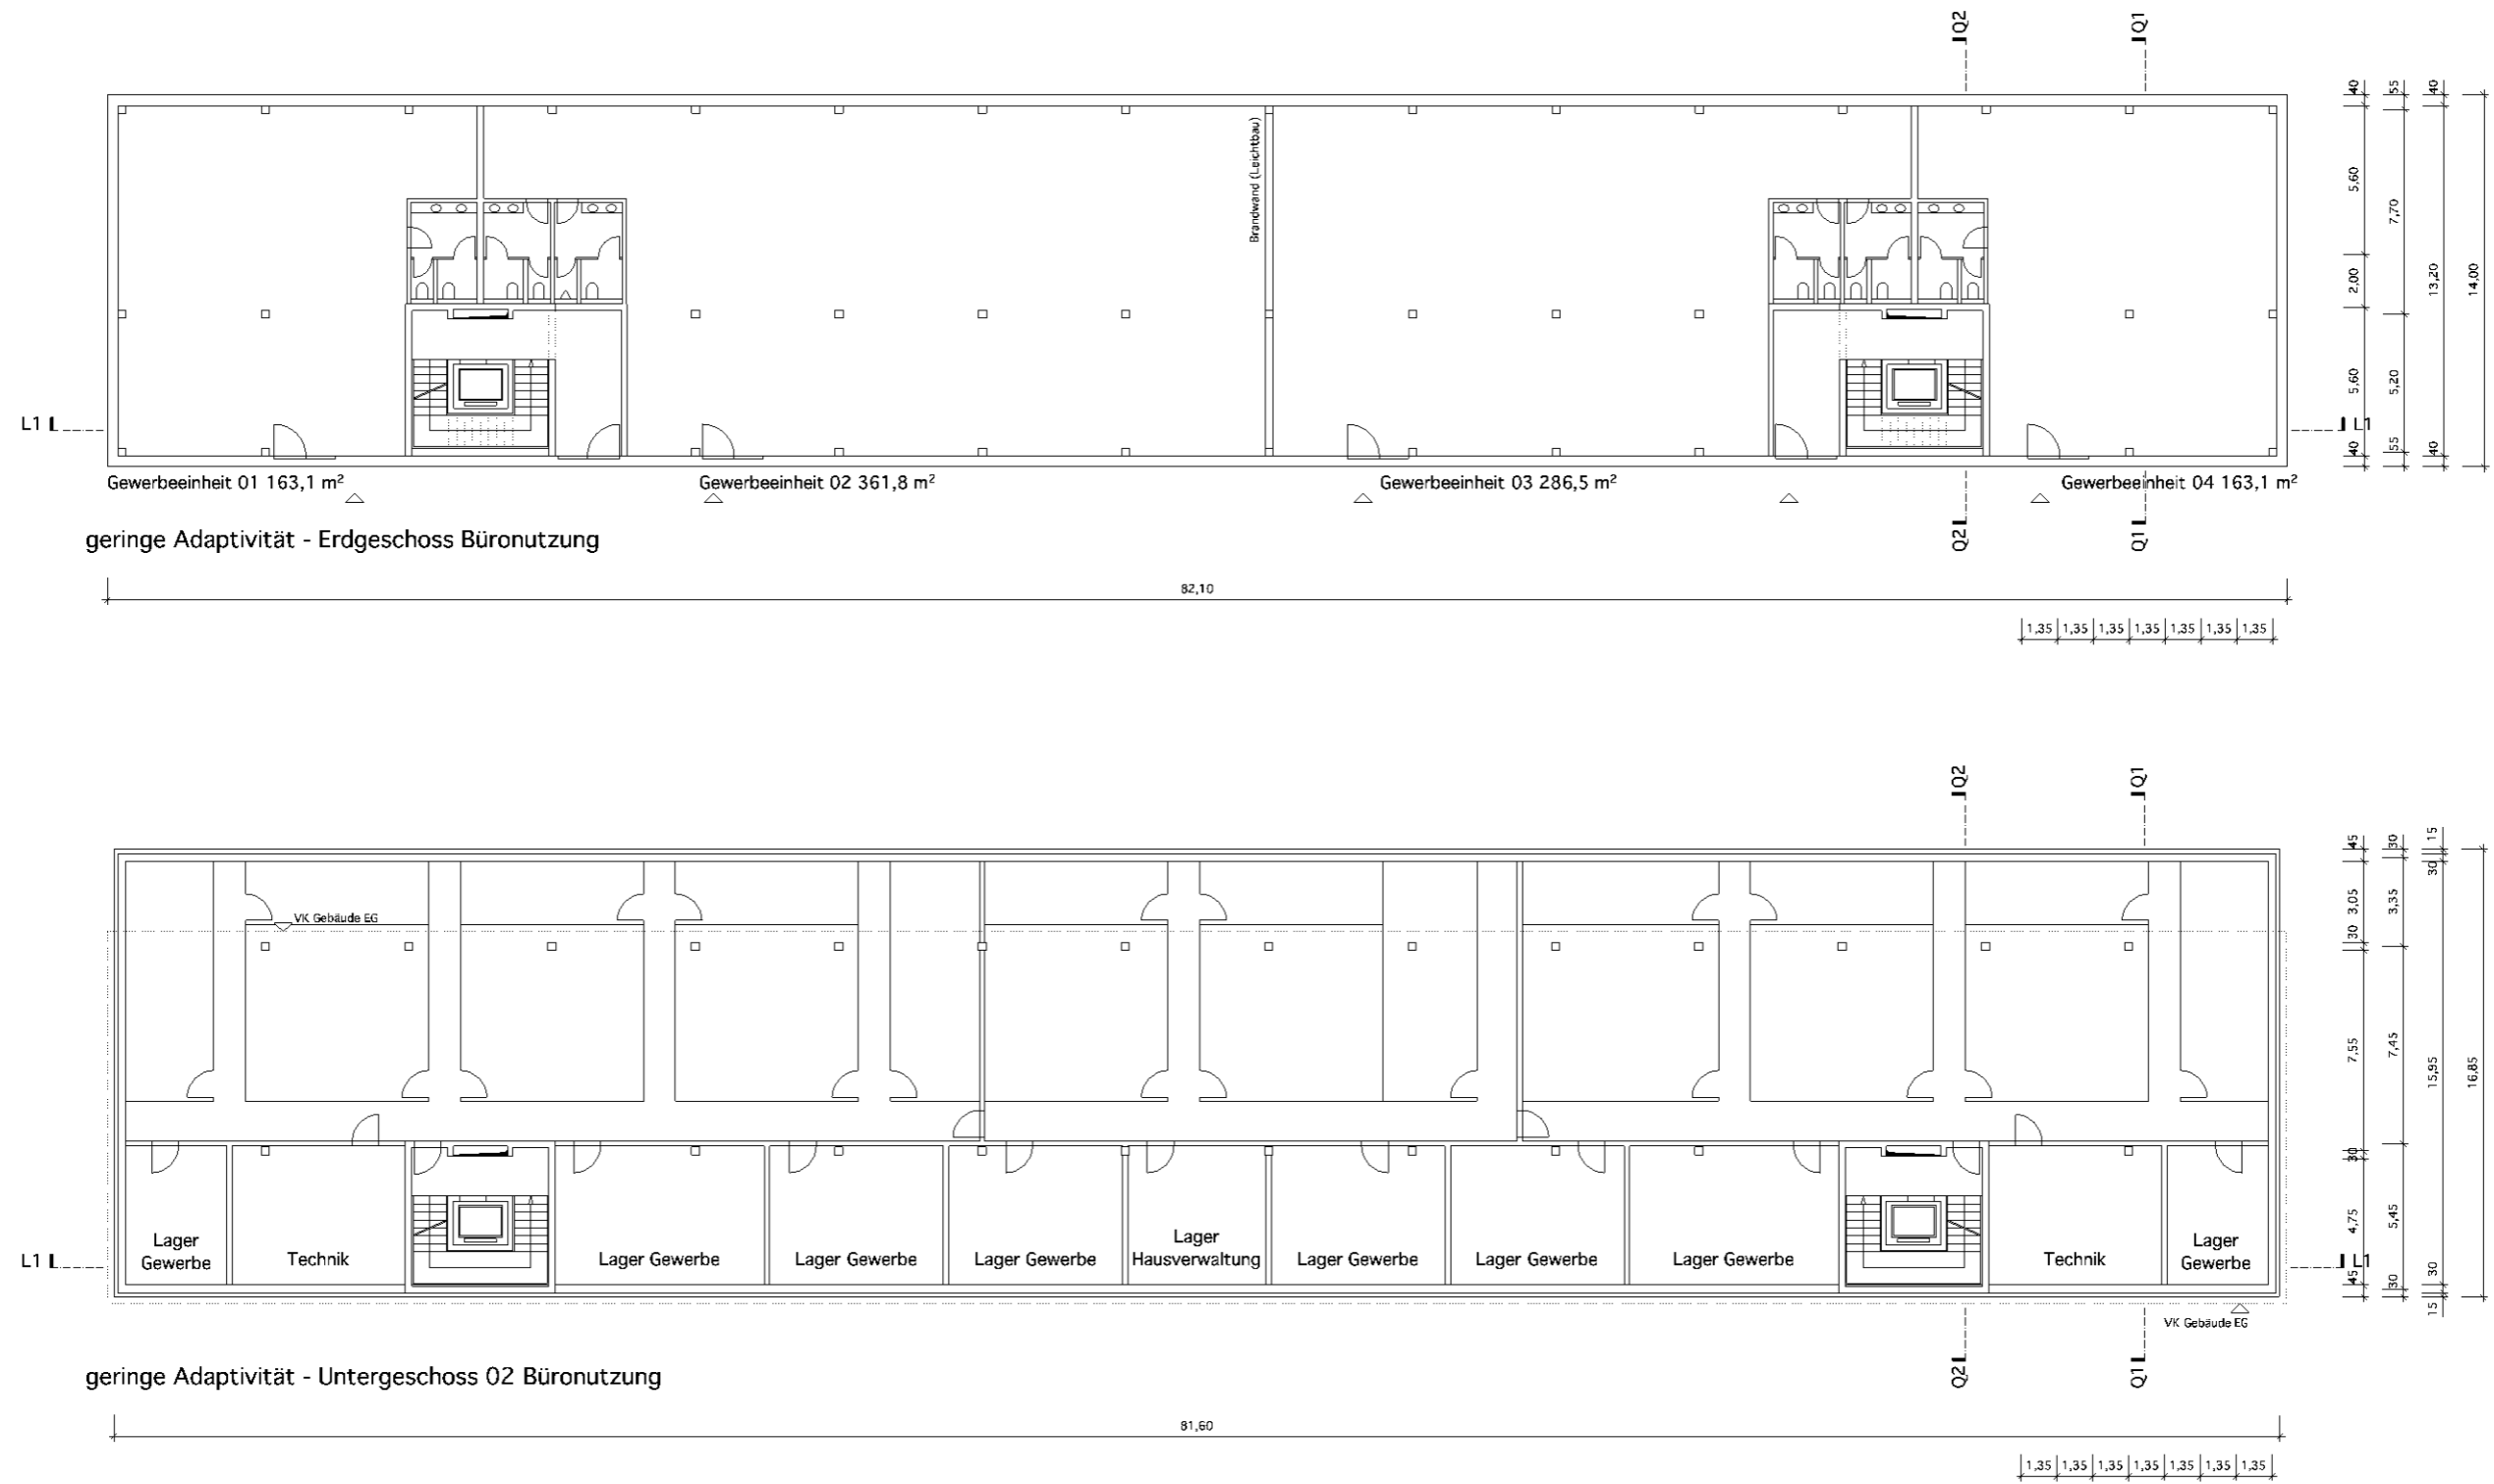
Grundrisse Erdgeschoss (oben) und Untergeschoss 02 (unten) des Referenzgebäudes „geringe Adaptivität“ für eine Büronutzung
